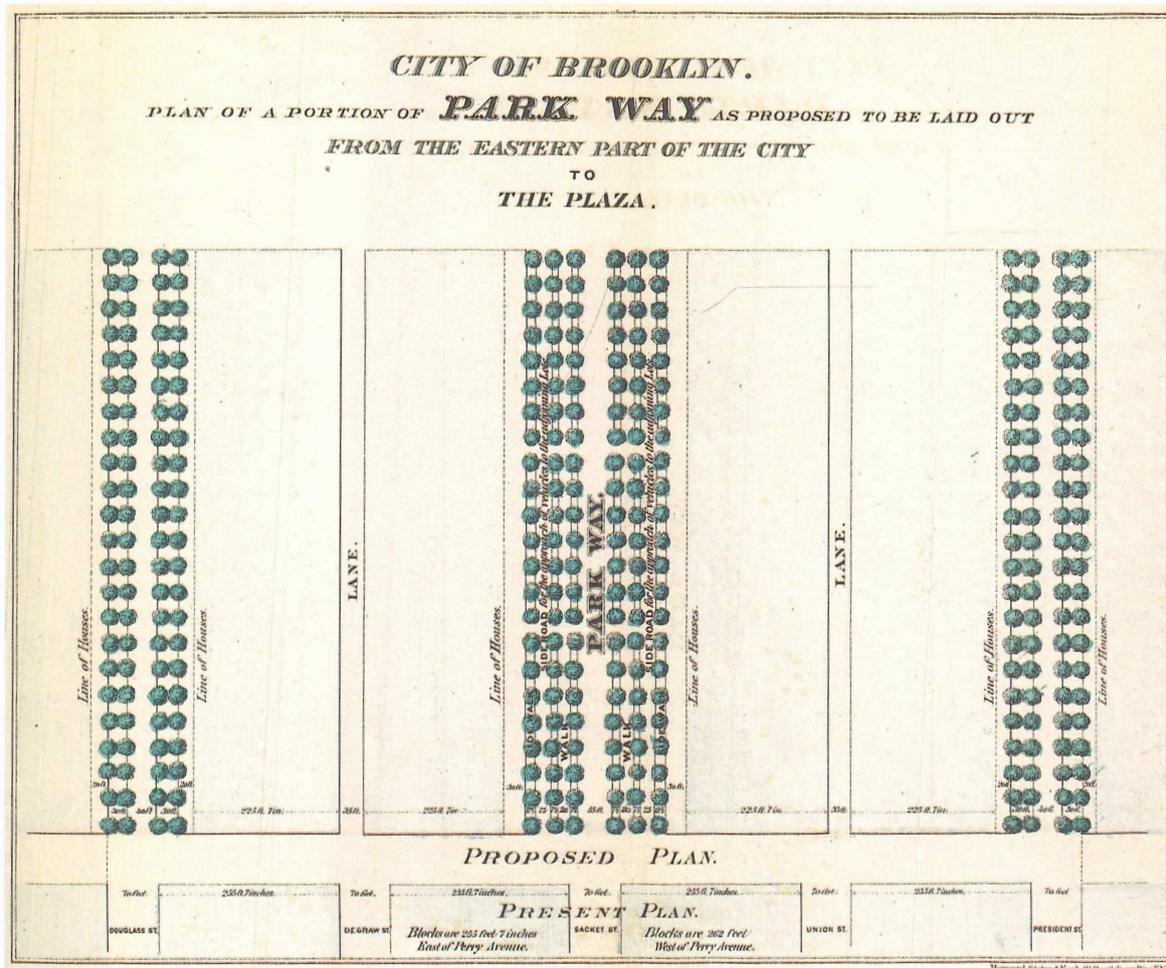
Plan préliminaire exposant les principes du parkway pour le Eastern Parkway, Brooklyn, Olmsted, Vaux & Co., 1868.
